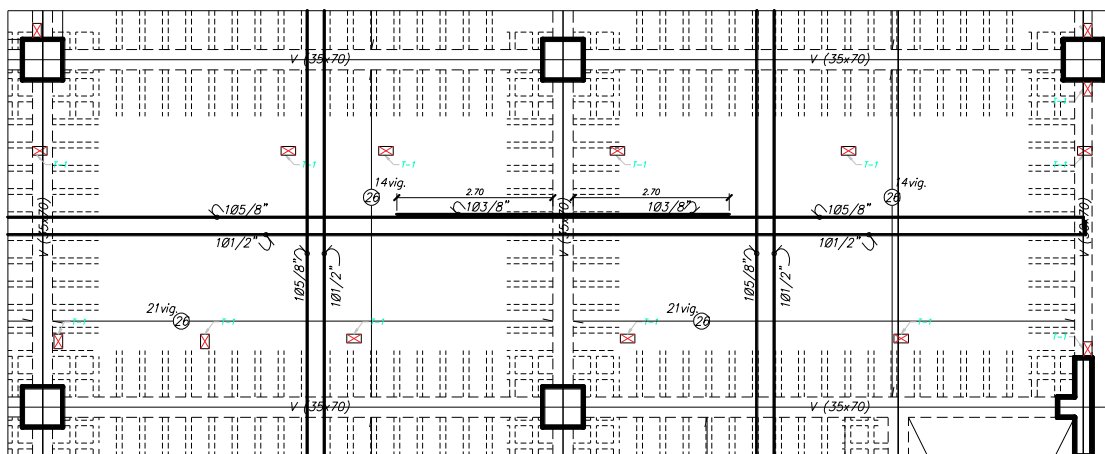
Plano de detalle de losa aligerada bidireccional. (Fuente Propia).
